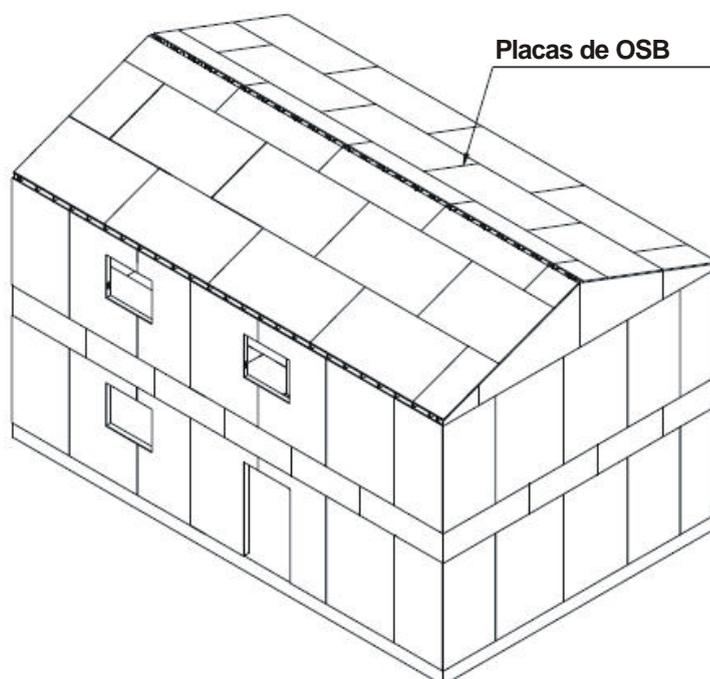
Assentamento das placas de OSB na estrutura. (Adaptado de Consul Steel, 2002)
